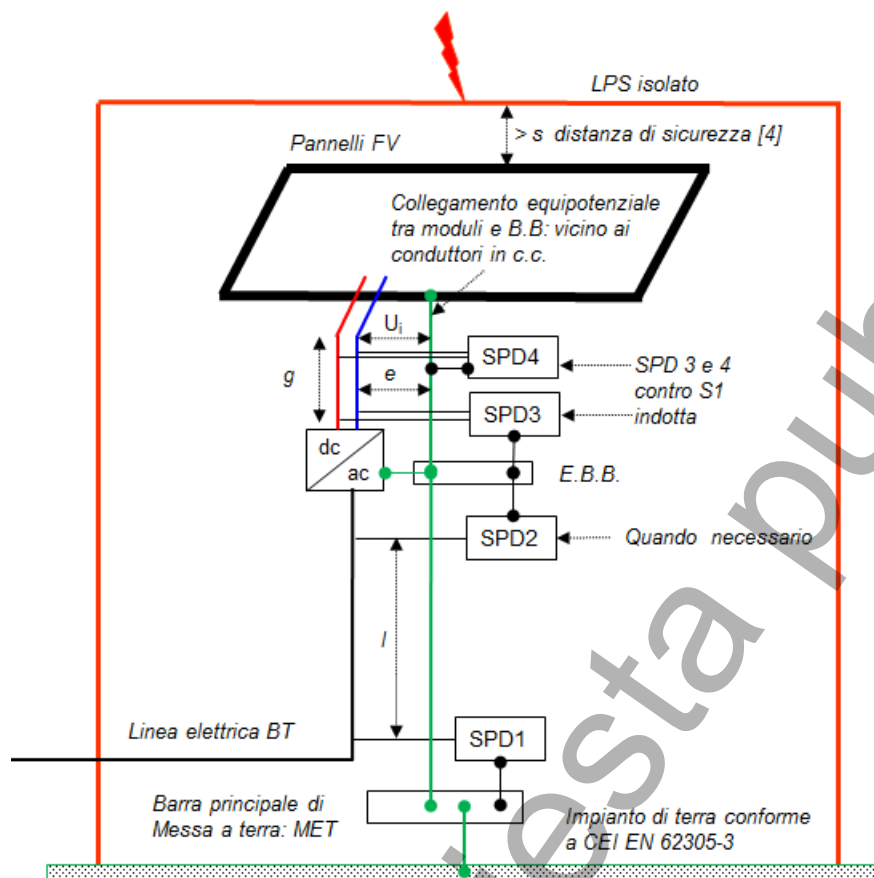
Edificio con LPS isolato dall'impianto FV
